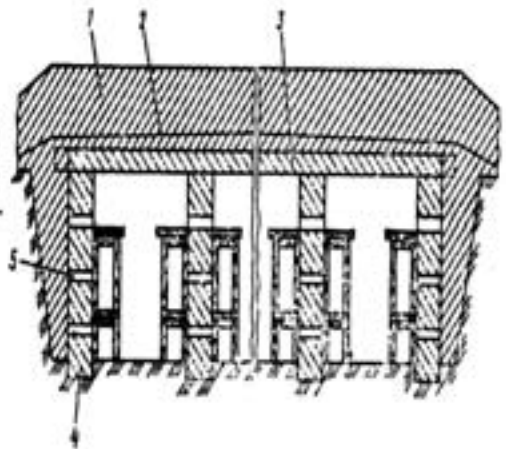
Трипрогонове ШСС із збірного залізобетону з вертикальними стінами із залізобетонних блоків:
